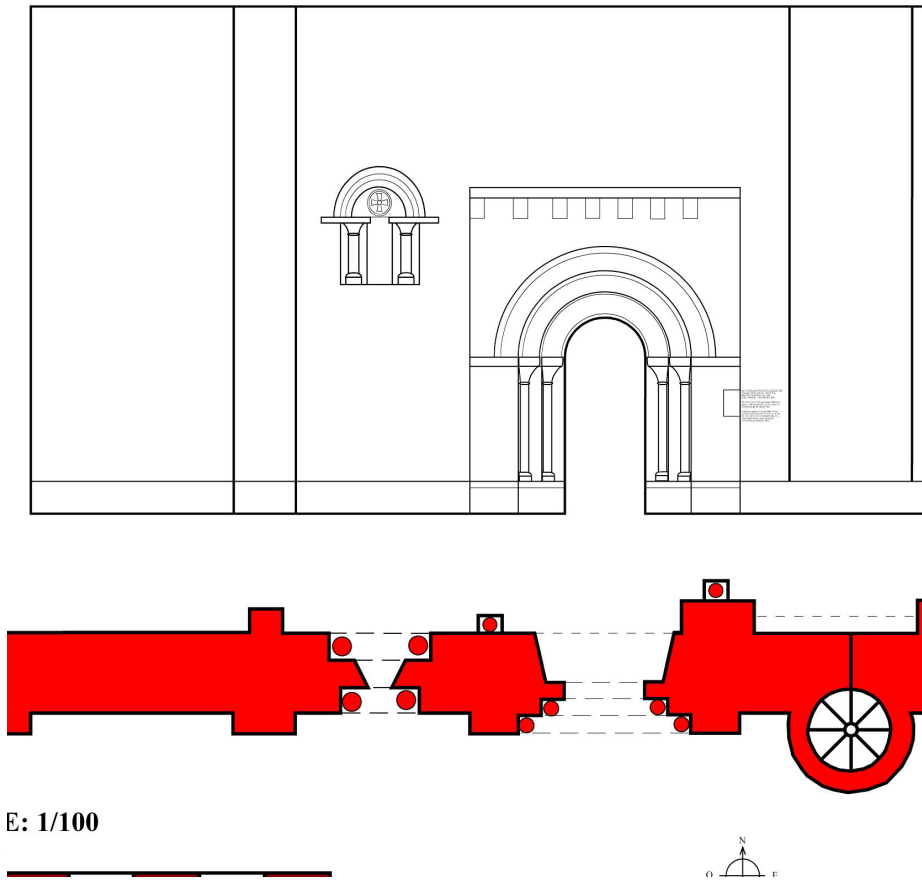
Alzado y planta de la fachada sur del templo de San Miguel (F. Palomero).
